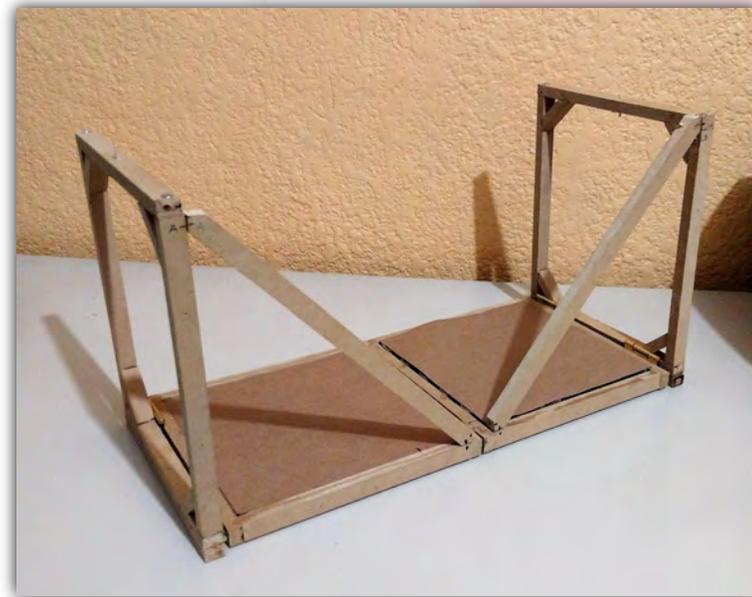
Posición final del conjunto piso - muros y colocación de soportes en diagonal para mantener fija la apertura de los muros.
